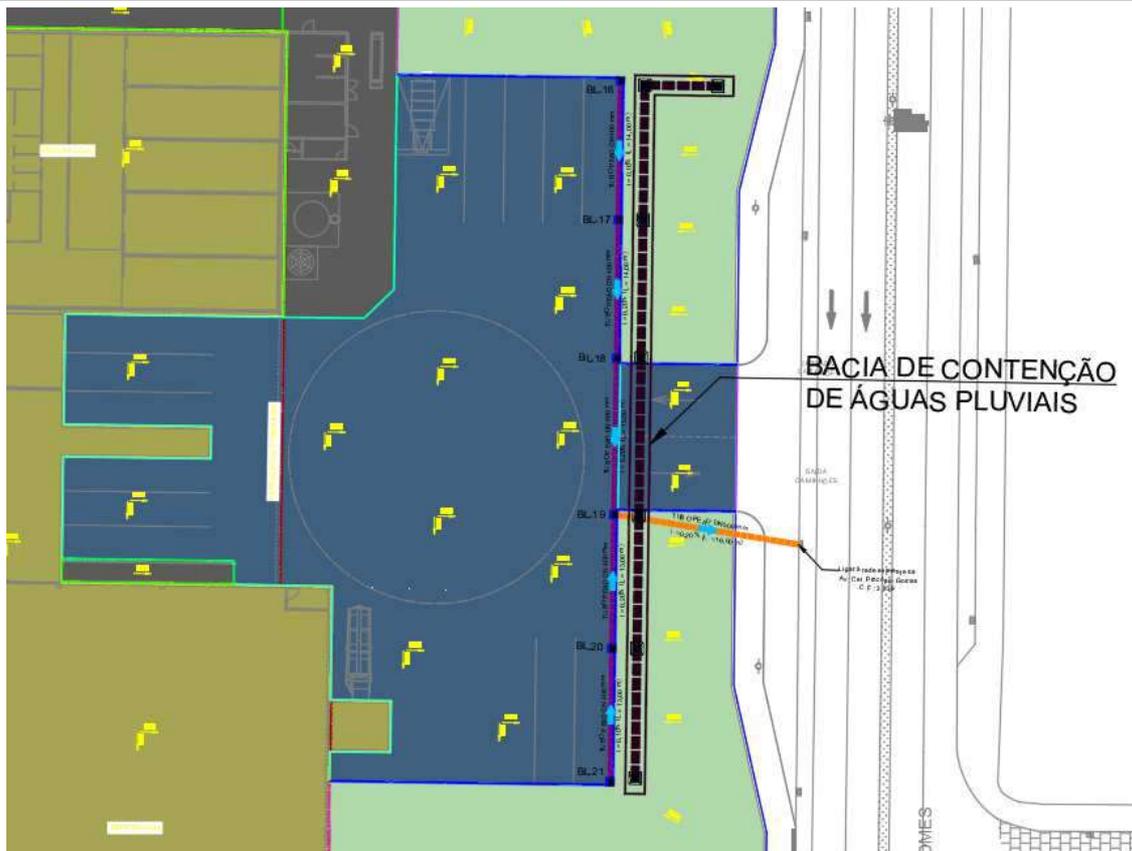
Projeto de drenagem – aproximado na bacia de contenção.
